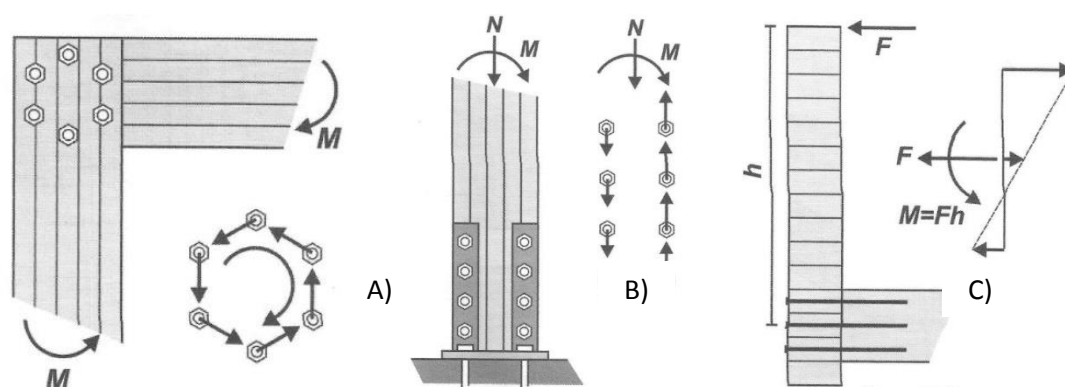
Exemplos de ligações em madeira: A) Ligação semi-rígida num nó de pórtico; B) Ligação base de pilar encastrado; C) Ligação da guarda de uma ponte de madeira (Negrão e Faria, 2009).
